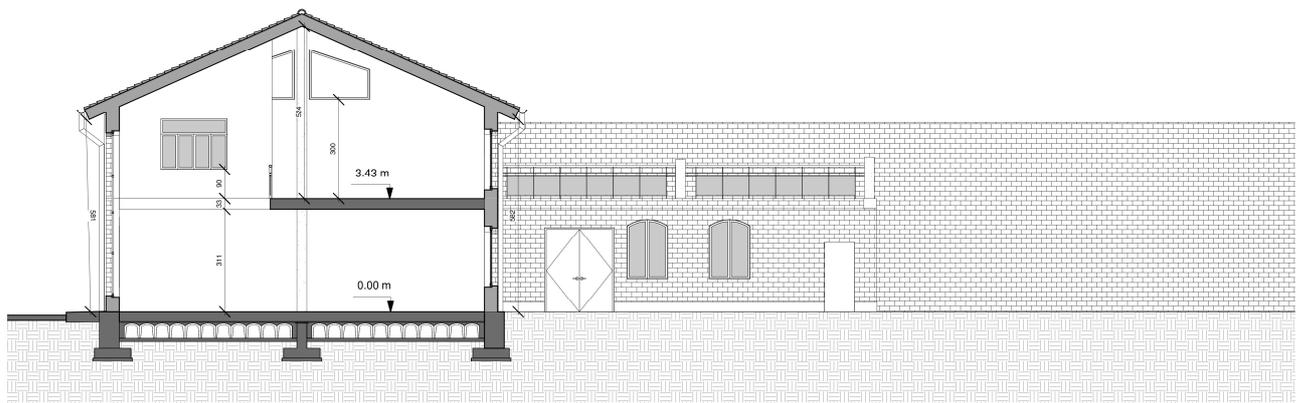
Sez. C-C (Tav. n° 8 scala 1:100)
